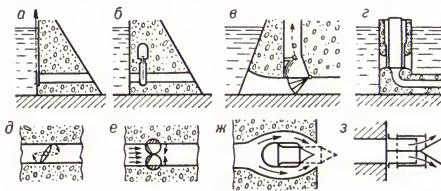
Схемы глубинных затворов: а — плоский; б — задвижка; в — сегментный; г — цилиндрический; д — дроссельный; е — шаровой; ж — игольчатый; з — конусный.
